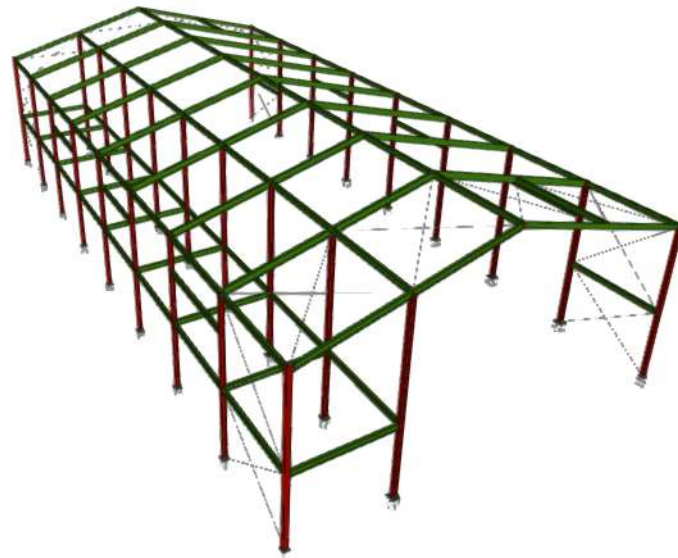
Estructura metálica dimensionada CUPE 3D
